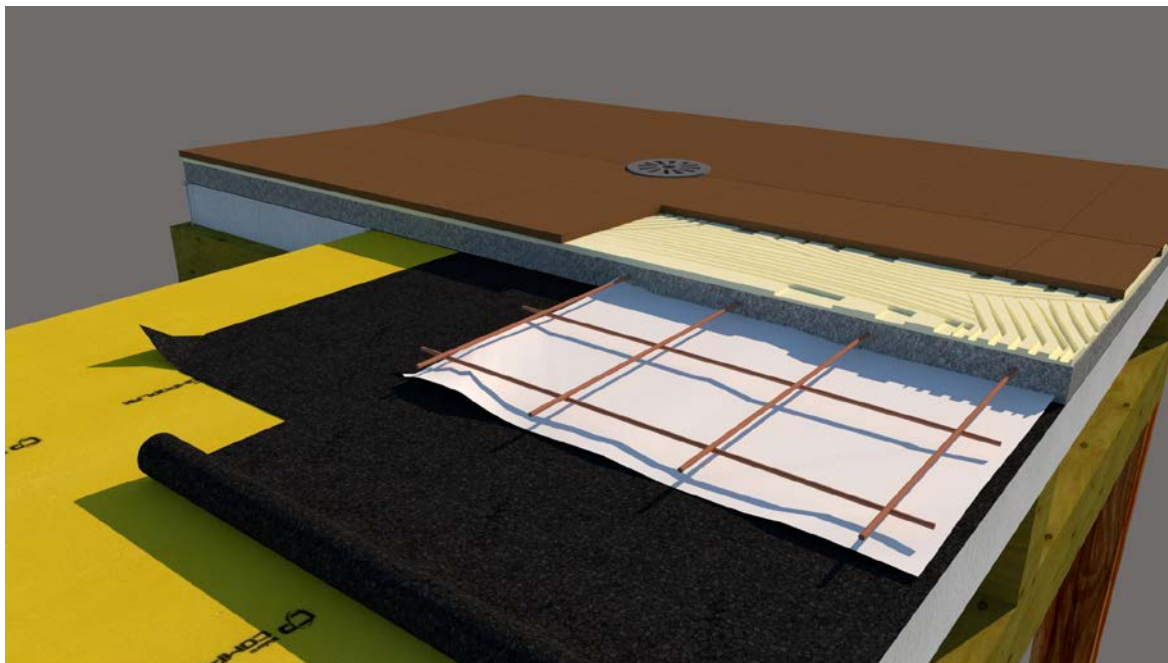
Detalle constructivo 3D de cubierta plana con Compoplak sobre estructura de madera
